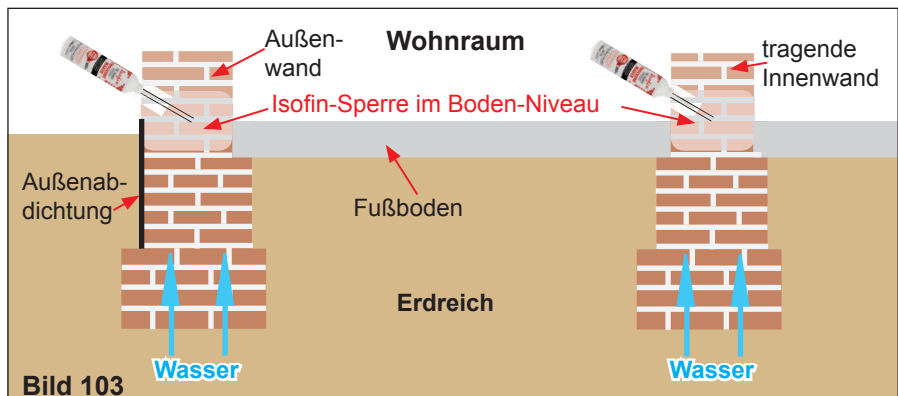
zeigt die Situation eines nichtunterkellerten Gebäudes mit Streifenfundamenten.
